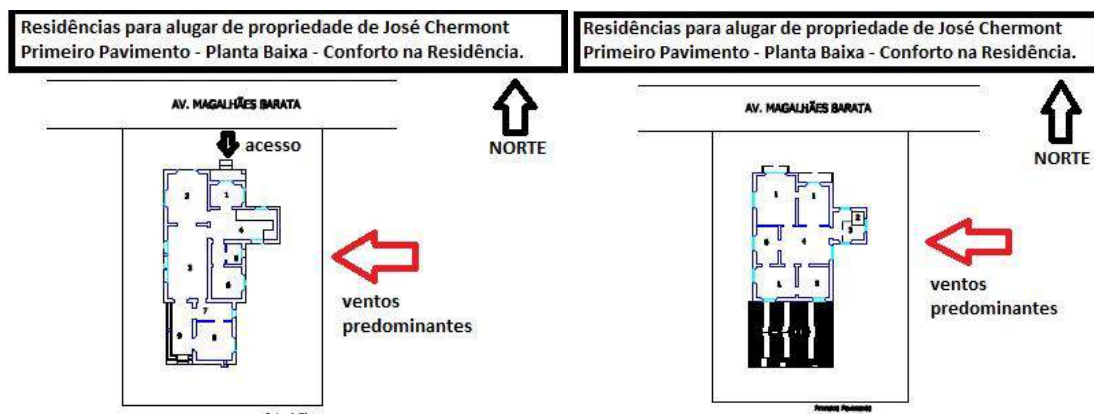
Planta de Conforto do pavimento térreo e do 1º pavimento das Residências para alugar de propriedade de José Leite Chermont (05).
